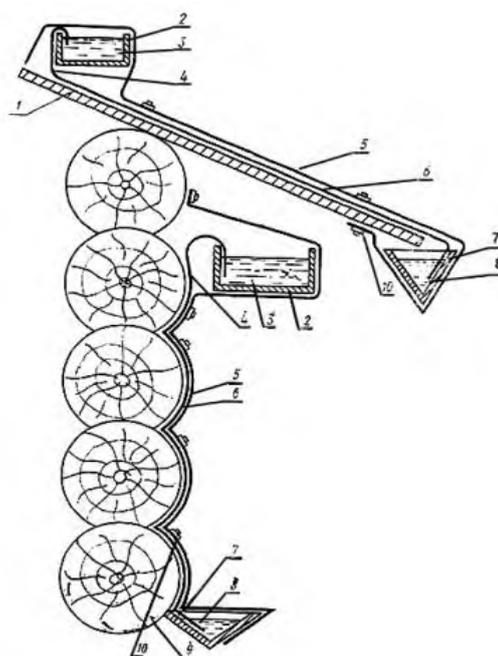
Схема панельной пропитки бревенчатой стены и дощатой кровли
